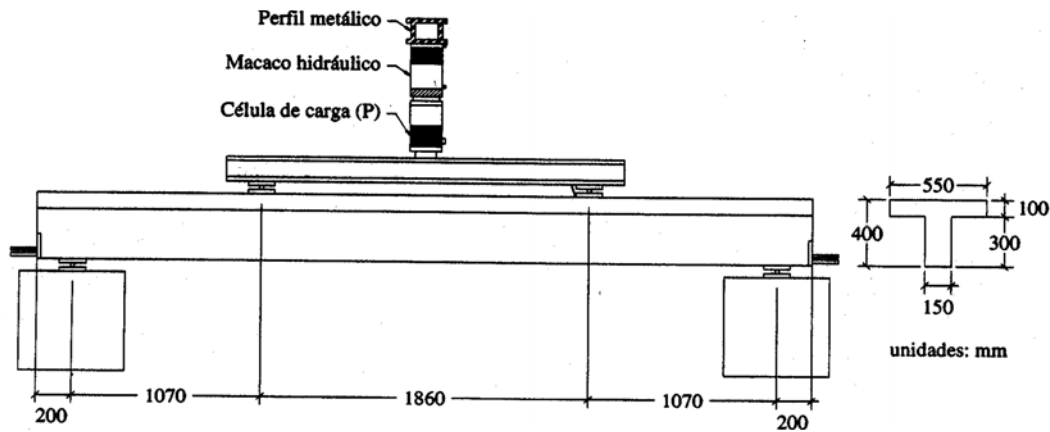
Esquema de carregamento e geometria da viga; adaptada de Silva Filho (2001).
